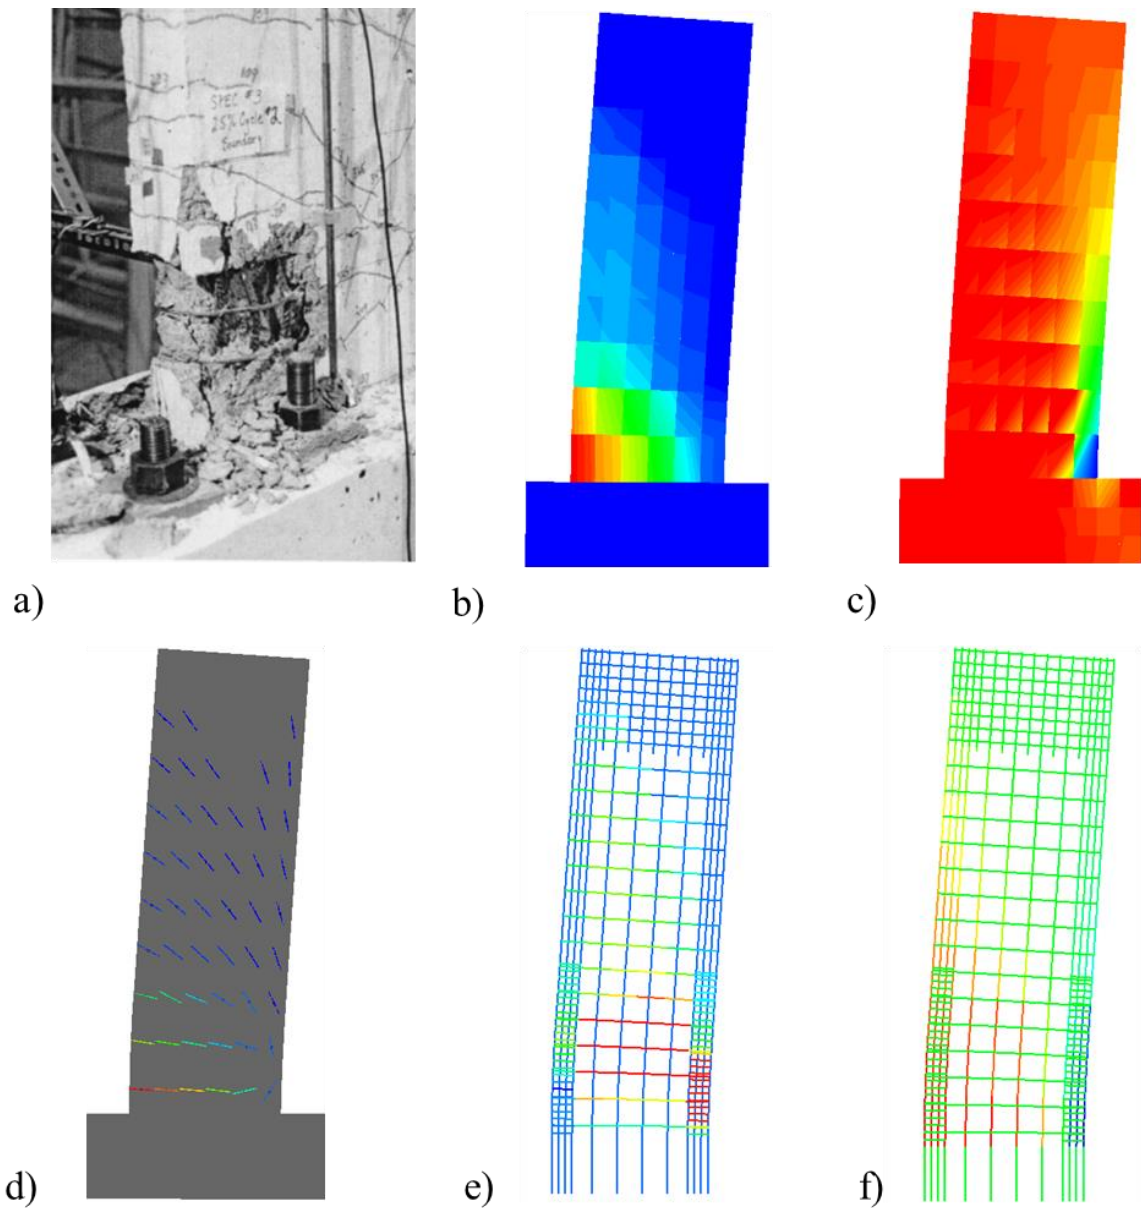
Comparación del estado de esfuerzos en el muro E cerca del punto de falla, a) Patrones de fisuración durante el ensayo al momento de la falla, b) deformaciones principales de tensión en el concreto, c) esfuerzos principales de compresión en el concreto, d) patrones de fisuración estimados, e) esfuerzos axiales en el refuerzo horizontal y f) esfuerzos axiales en el refuerzo vertical
